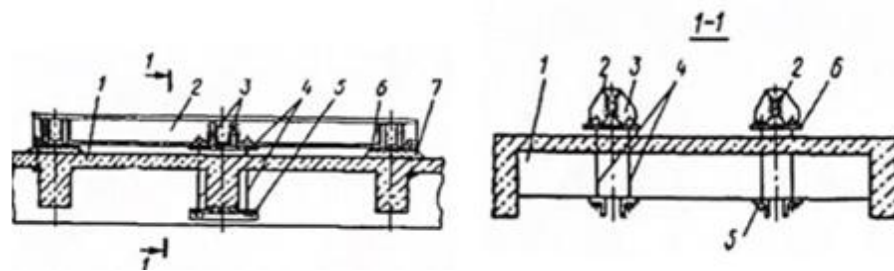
Усиление балки и плиты перекрытия металлическими балками сверху:
